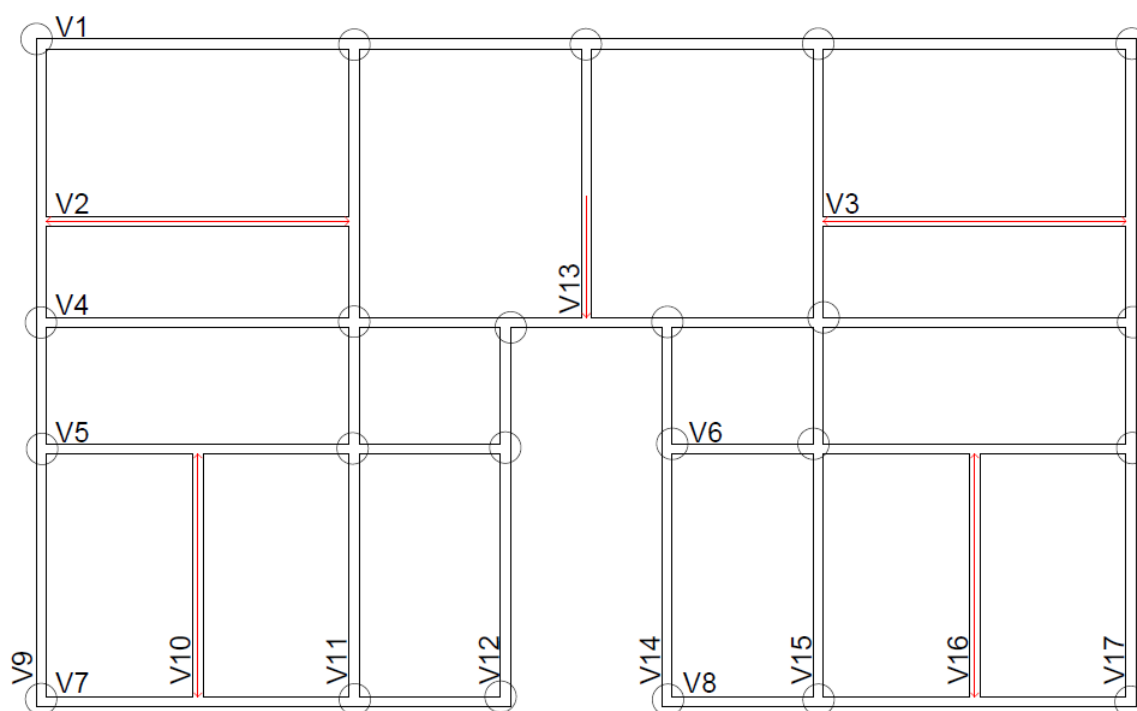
Distribuição das reações laterais das lajes nas vigas
